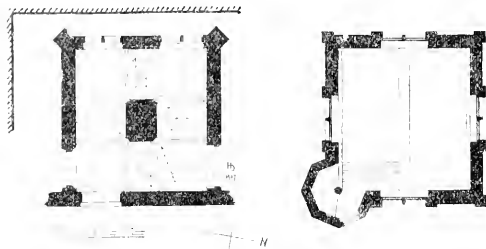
Plan du rez-de-chaussée et du dernier étage.
